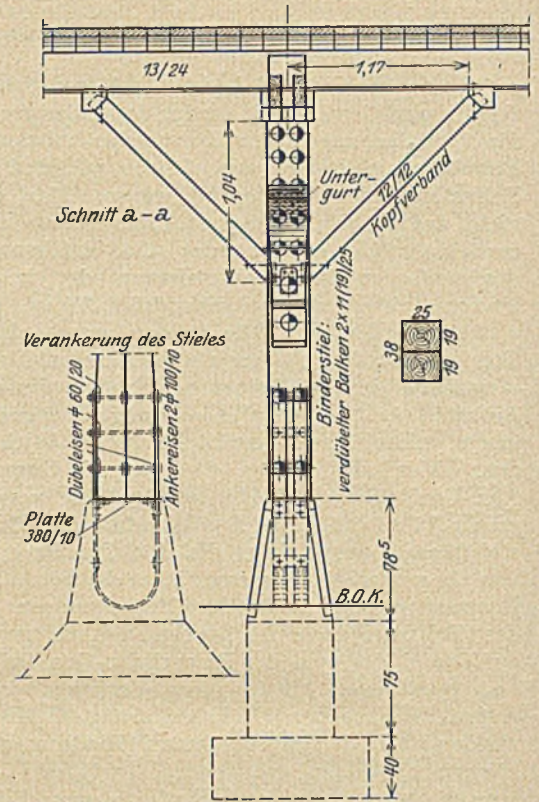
Ansicht des Binderstieles mit Verankerungen.
